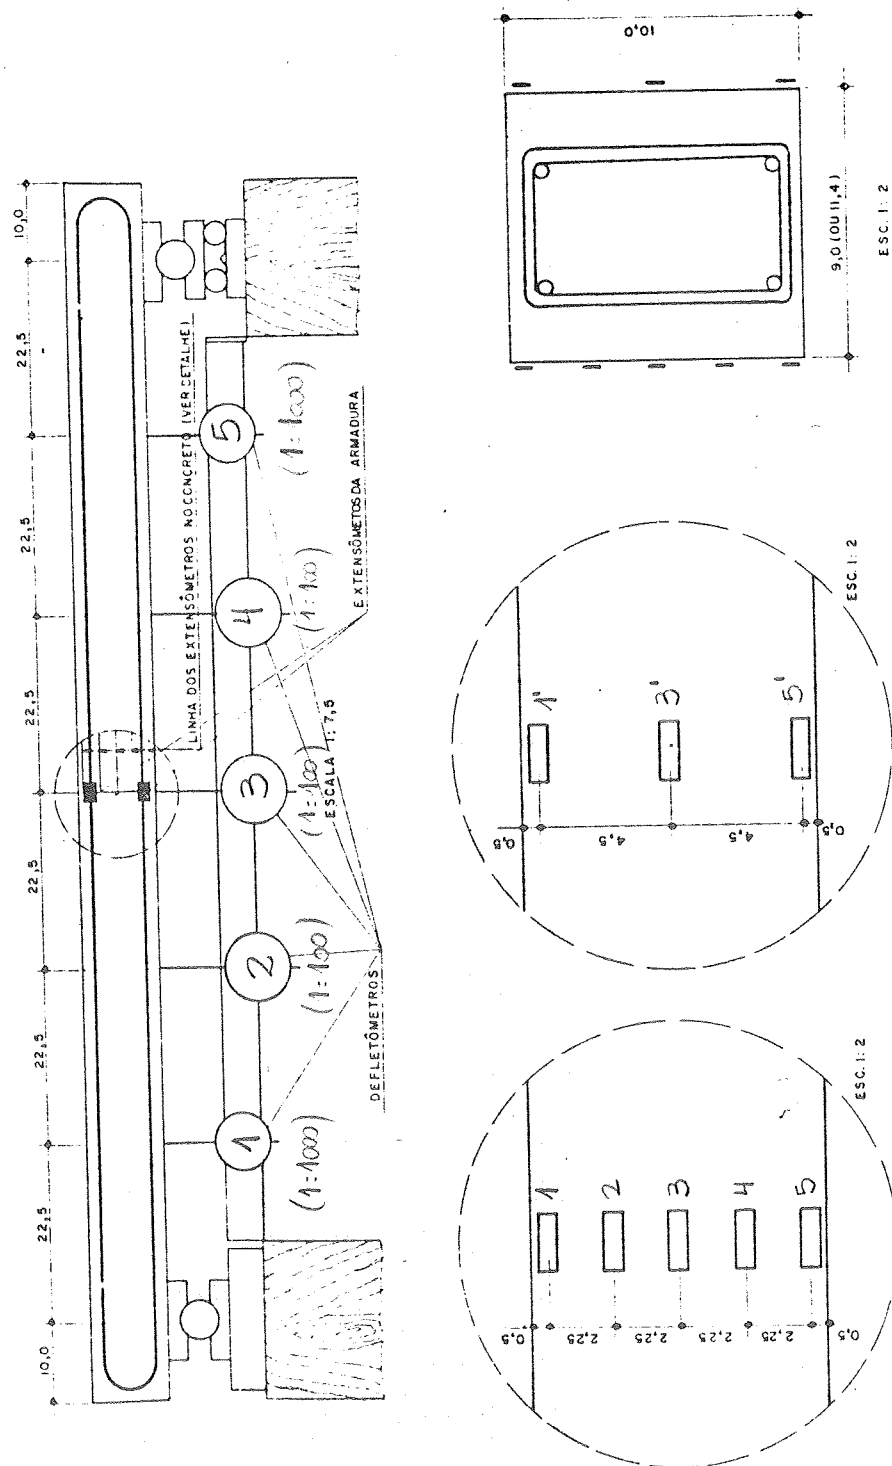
Características das Vigas Ensaaiadas-Eschema de Carregamento e Instrumentação (MARTINELLI,1974)
